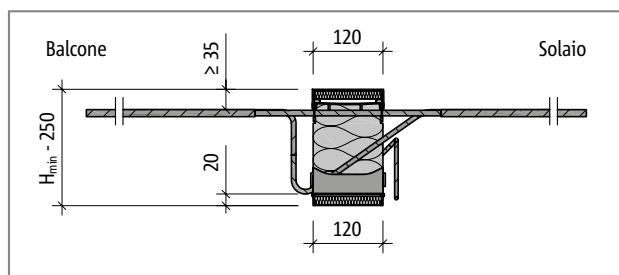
Schöck Isokorb® tipo da KXT55 a KXT100, REI120: sezione dell'elemento
